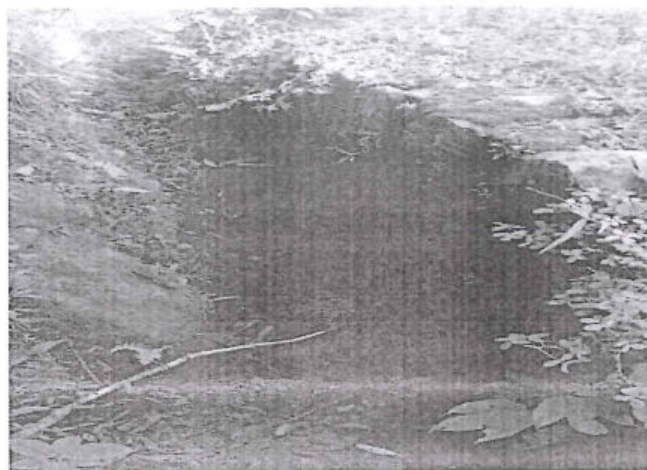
Alcantarilla de concreto, en regular condición Prog. 3+975
